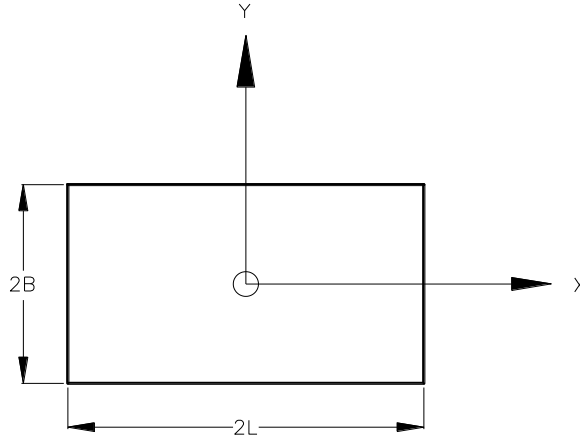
Geometría de la cimentación y definición de ejes globales
